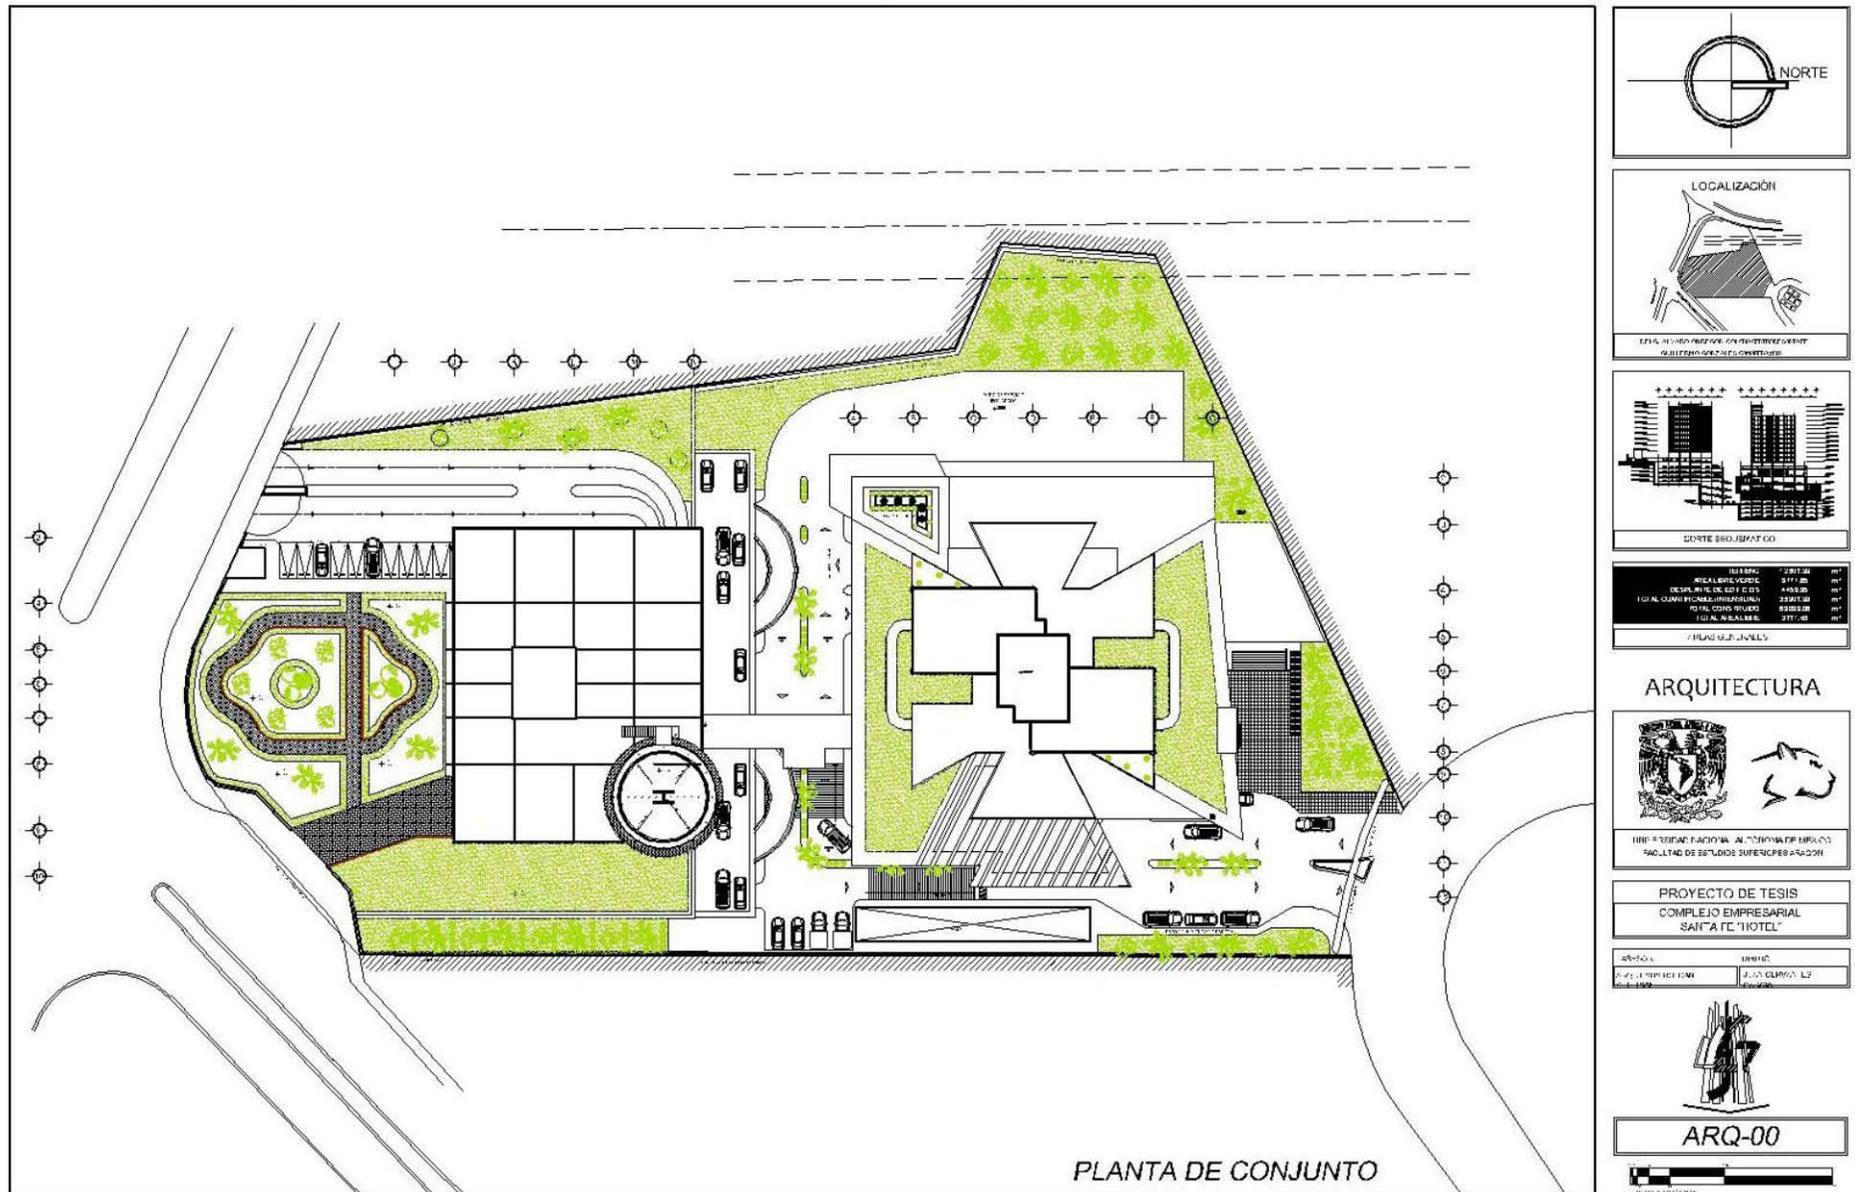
Plano ARQ-00; Planta de Conjunto. Edición propia.
